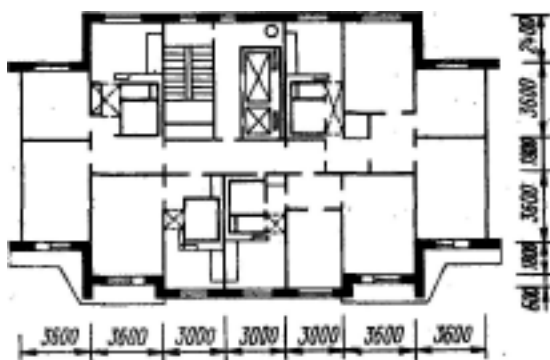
Крупнопанельный 16—17-этажный дом серии П-44 (план секции)
